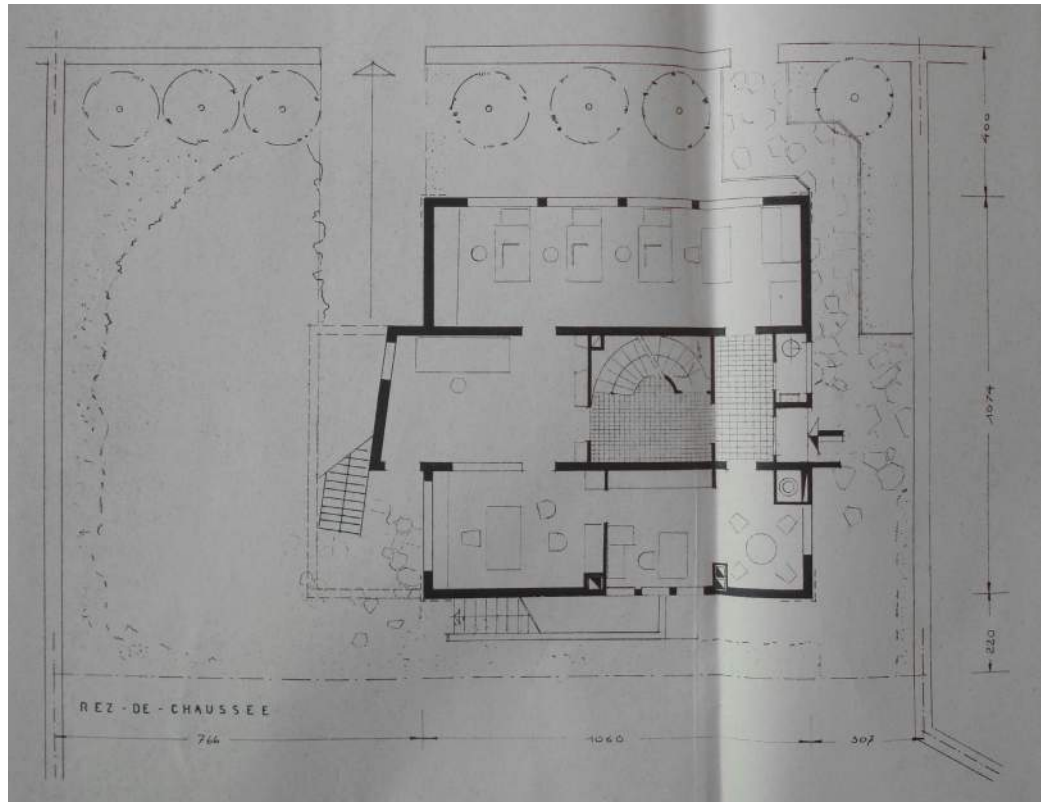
Grundriss, Erdgeschoß mit Büroräumen (1956)
